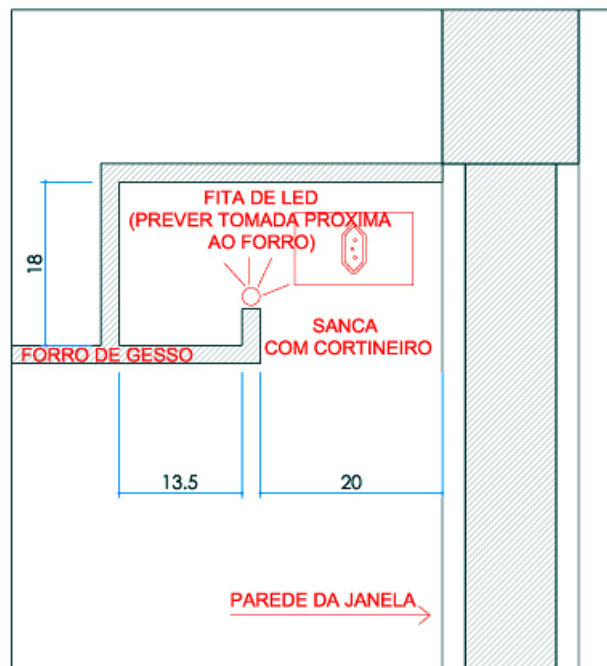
Planta baixa de forro para detalhamento de gesso Fonte: Acesso em: 08/02/2016
